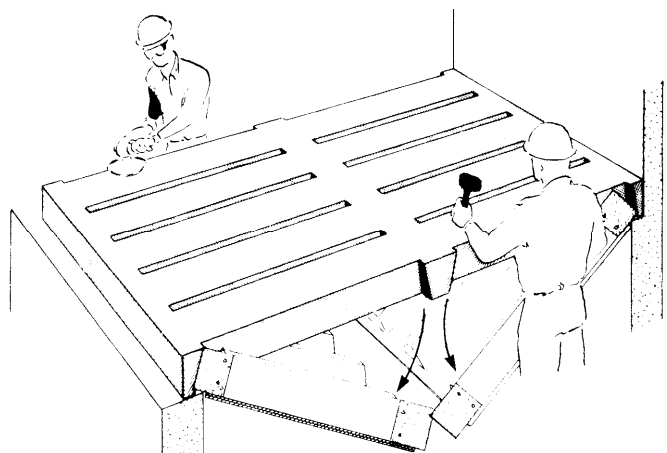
Les planchers à lattes peuvent être coulés en place au moyen de coffrage d'acier ou de bois démontables.
